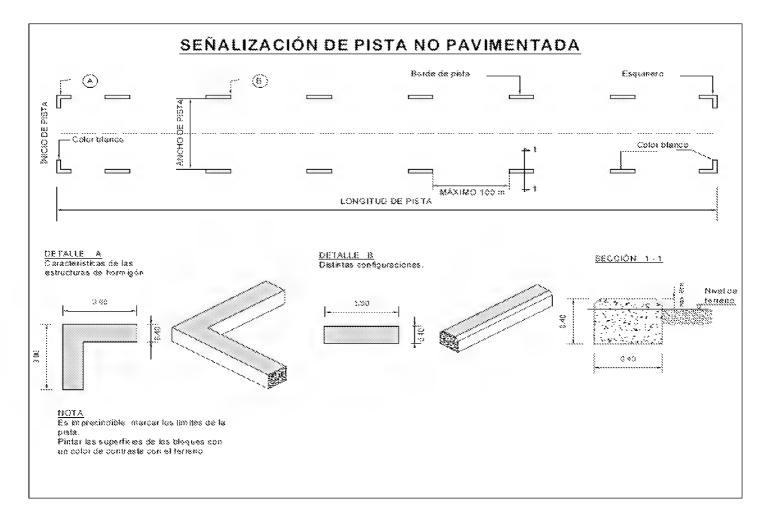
36 A Balizas de borde de pistas sin pavimentar tipo A
